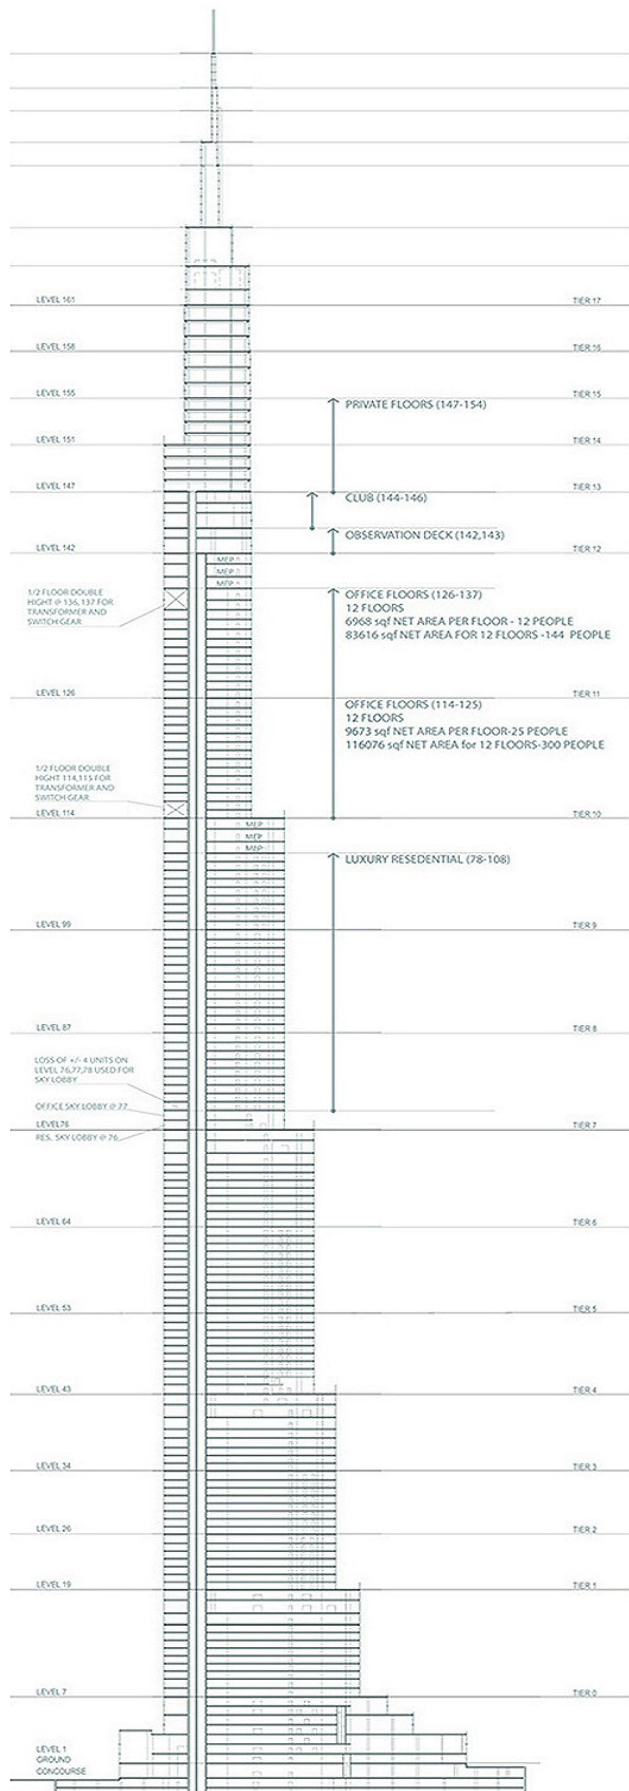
Sección y PLANTAS TIPO DEL BURJ KHALIFA.
